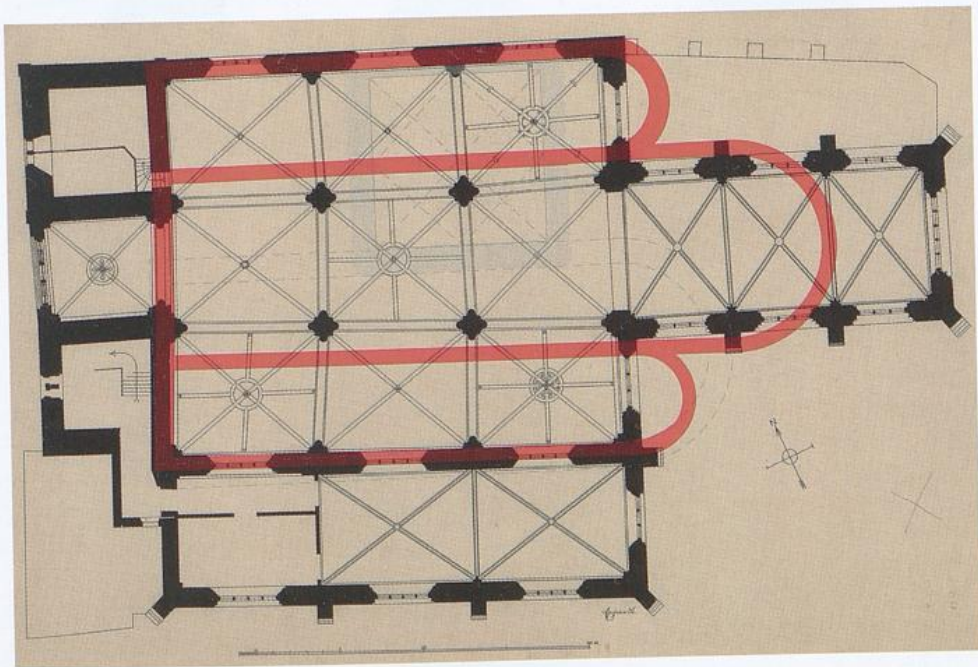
Unser Lieben Frauen, Grundriss Bau III um 1160
